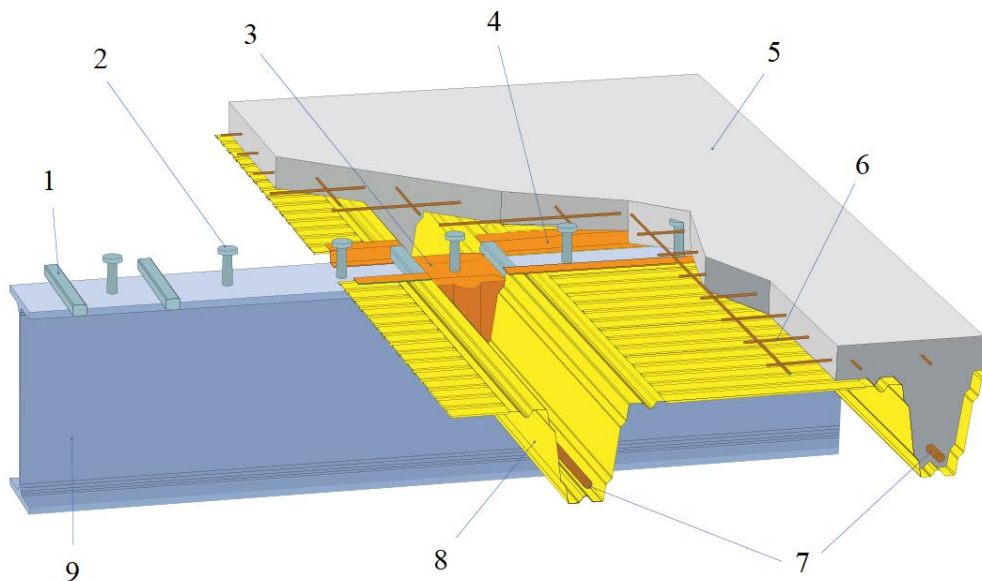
Плита перекрытия по профнастилу: (1) – стальной опорный элемент, (2) – гайка-болт, (3) – пластиковая уплотнительная крышка, (4) – зигзагообразный профиль, (5) – железобетонная плита, (6) – арматурная сетка, (7) – продольная рабочая арматура плиты, (8) – стальной трапециевидный профнастил *TRP200*, (9) – стальная балка.
